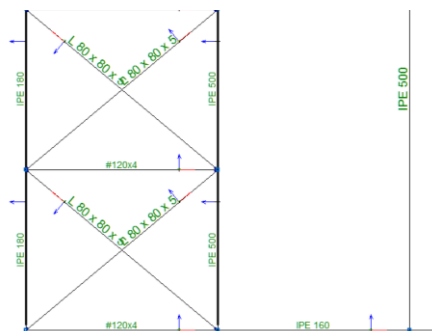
Sistema contraviento de cubierta con detalle de perfiles
